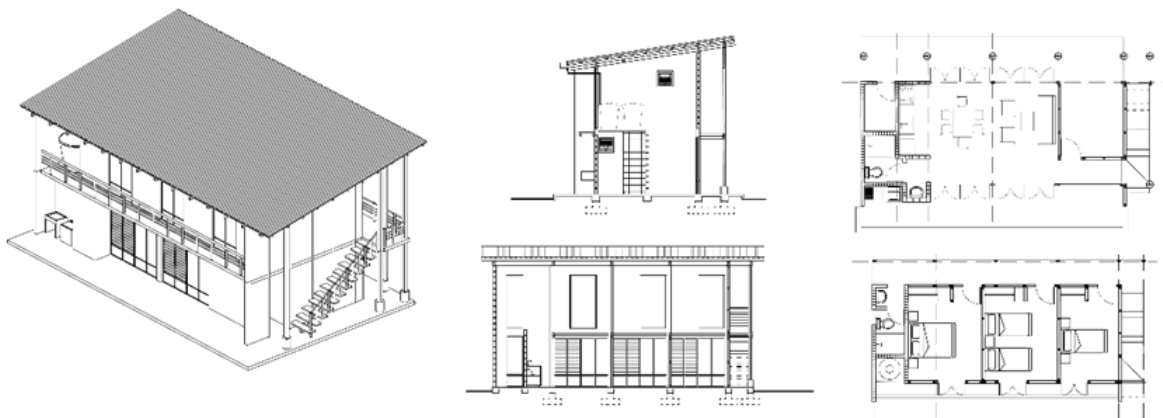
Proyecto arquitectónico (plantas, cortes y volumetría). Fuente: Elaboración propia a partir de Ramírez G. Collazos V. y Navarro A, 2015.
